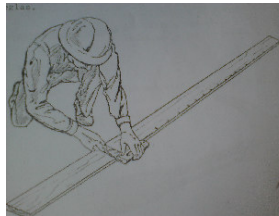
Trabajador marcando un escantillón (SENCICO 1991)
